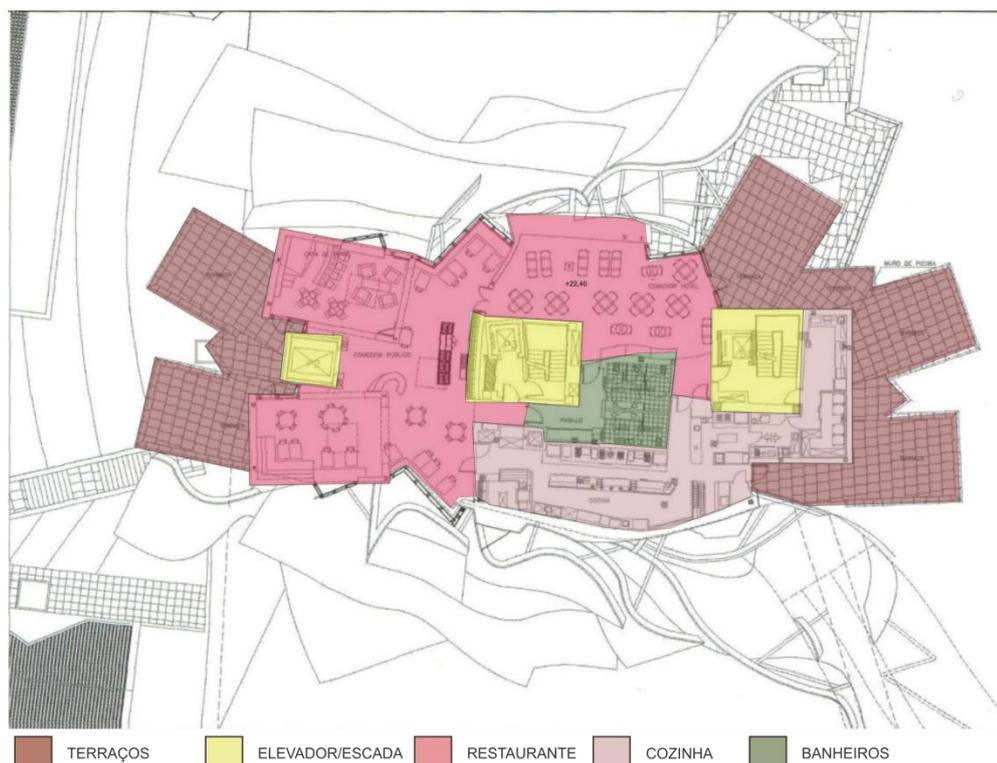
Planta baixa, Ambientes, 2º pavimento.
